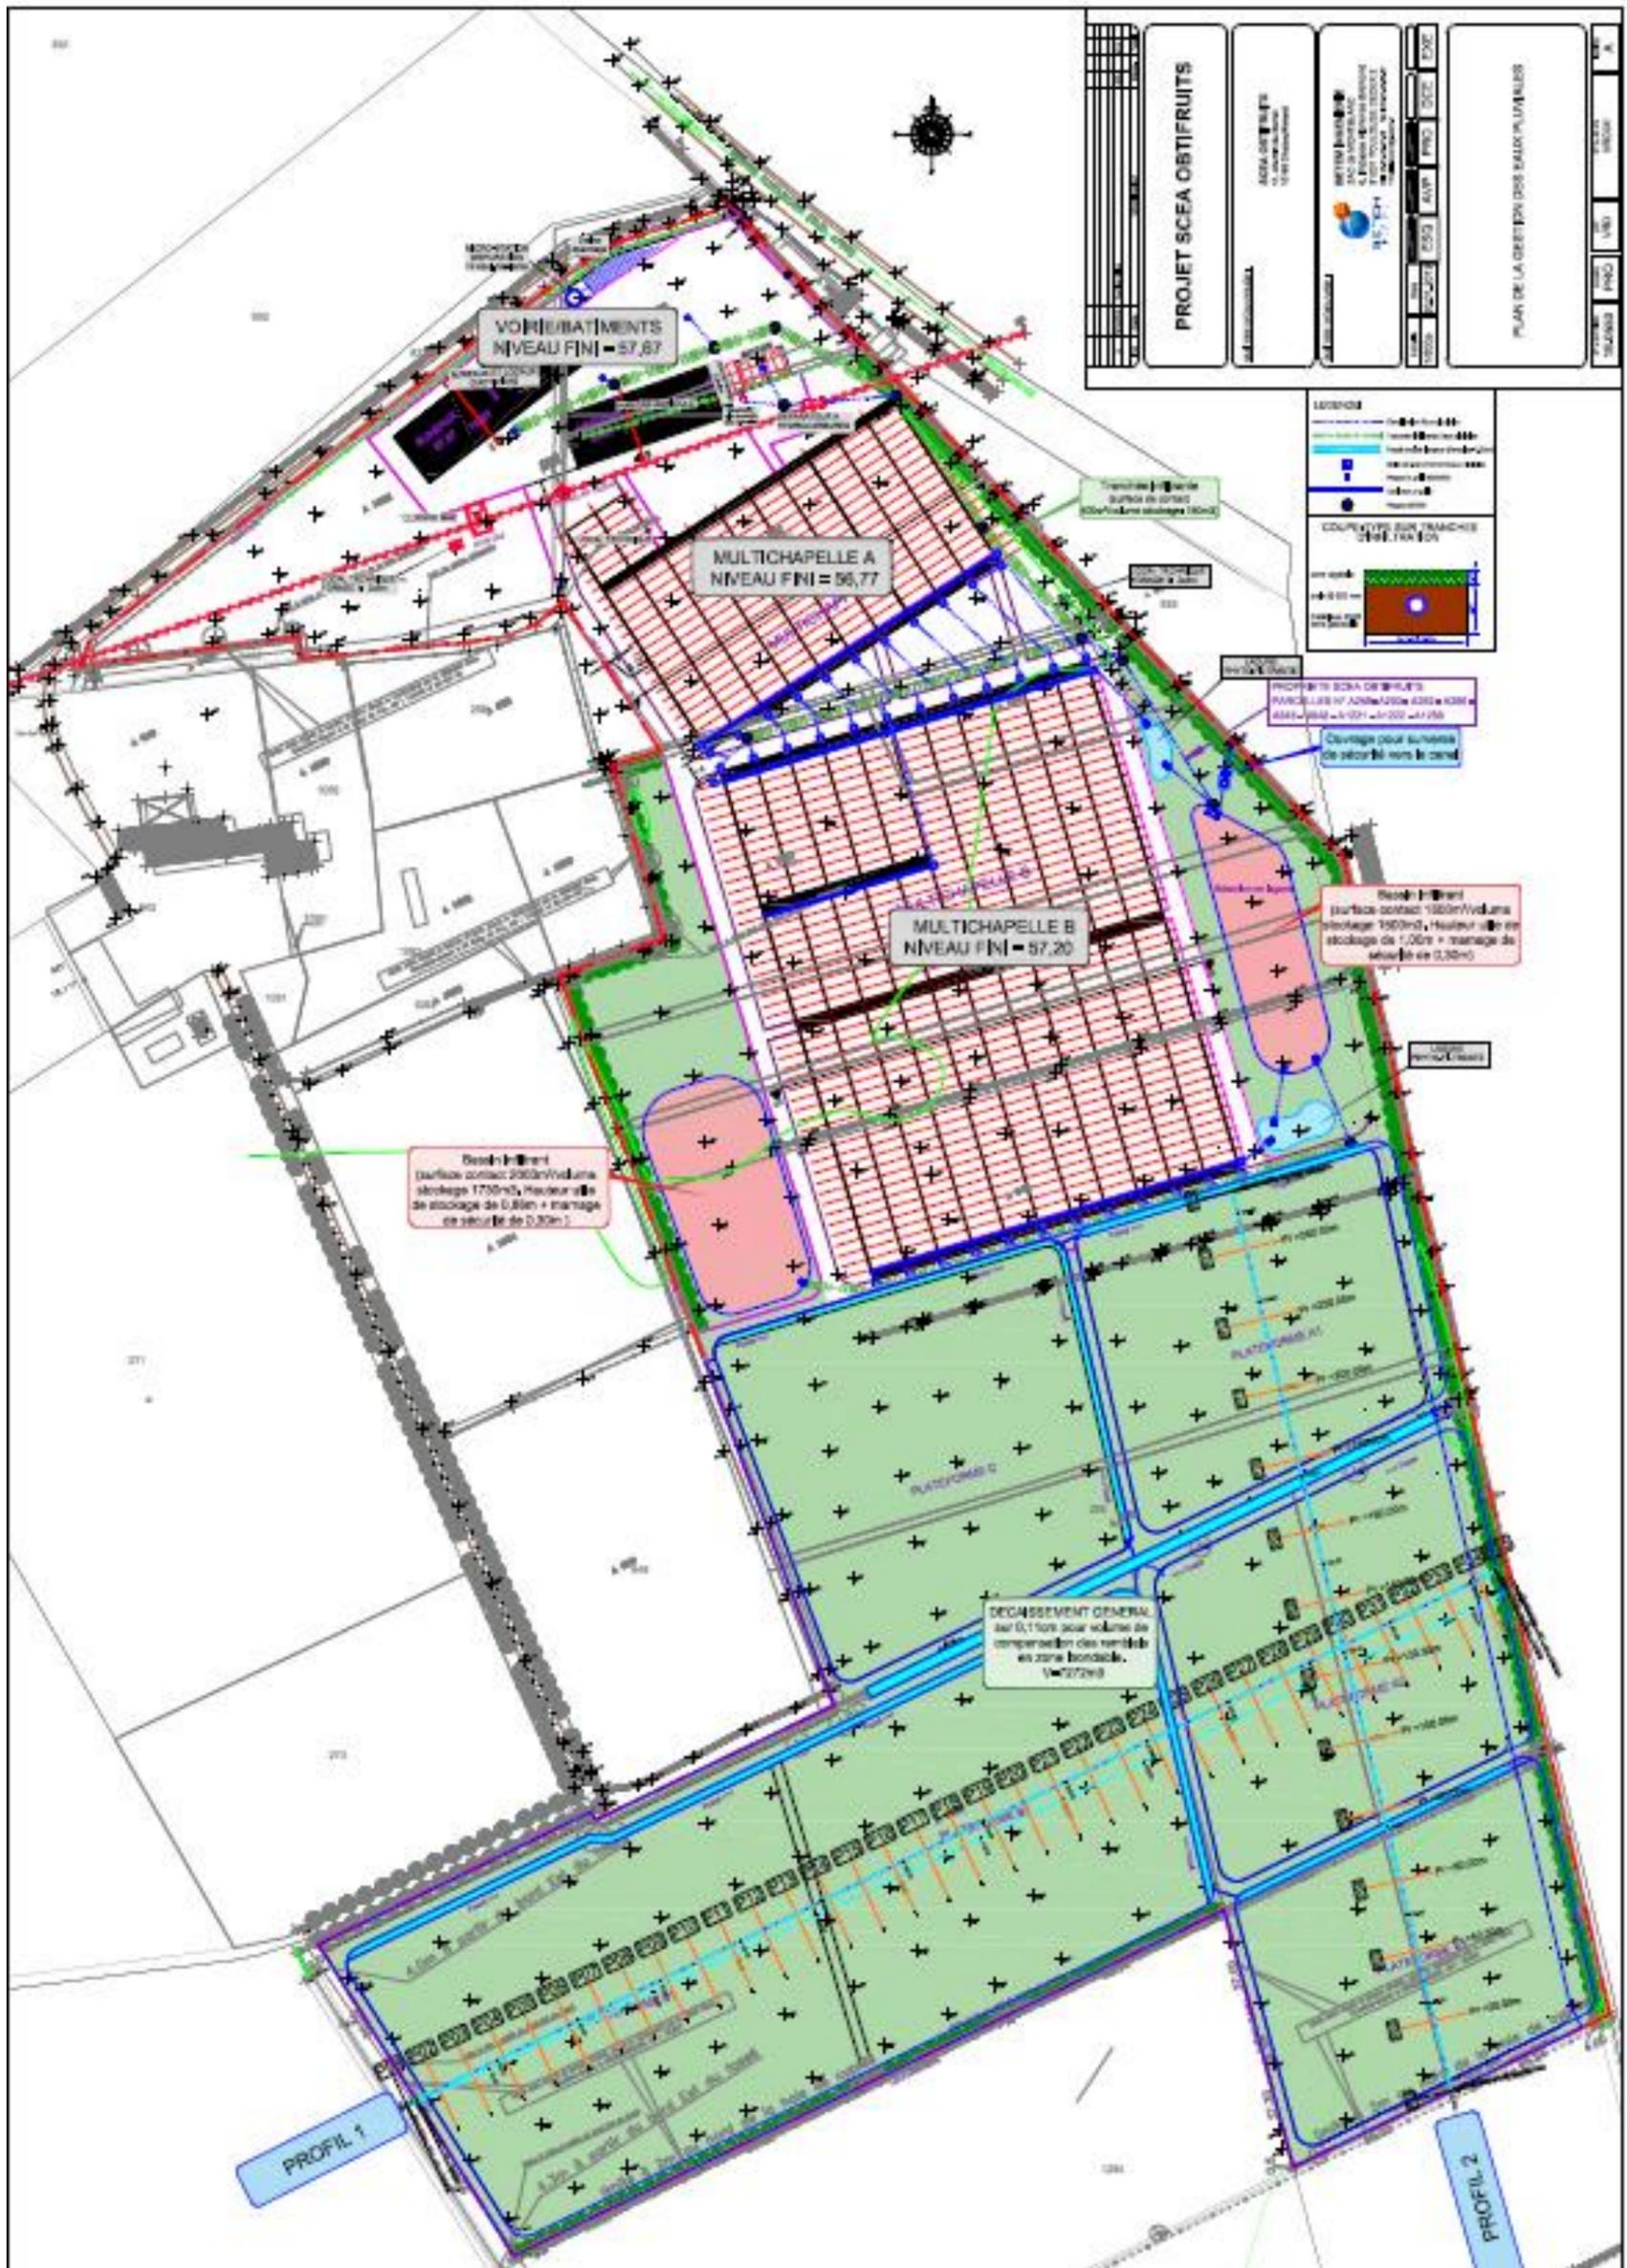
Plan de masse du projet (source : BETEM, 30/02/19)
